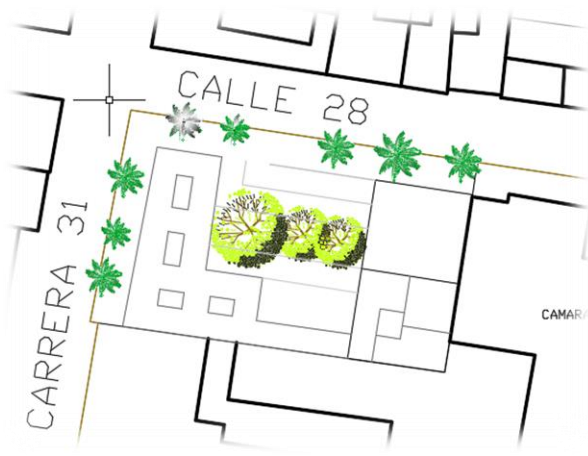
Planta primer esquema de diseño. Fuente Propia.
